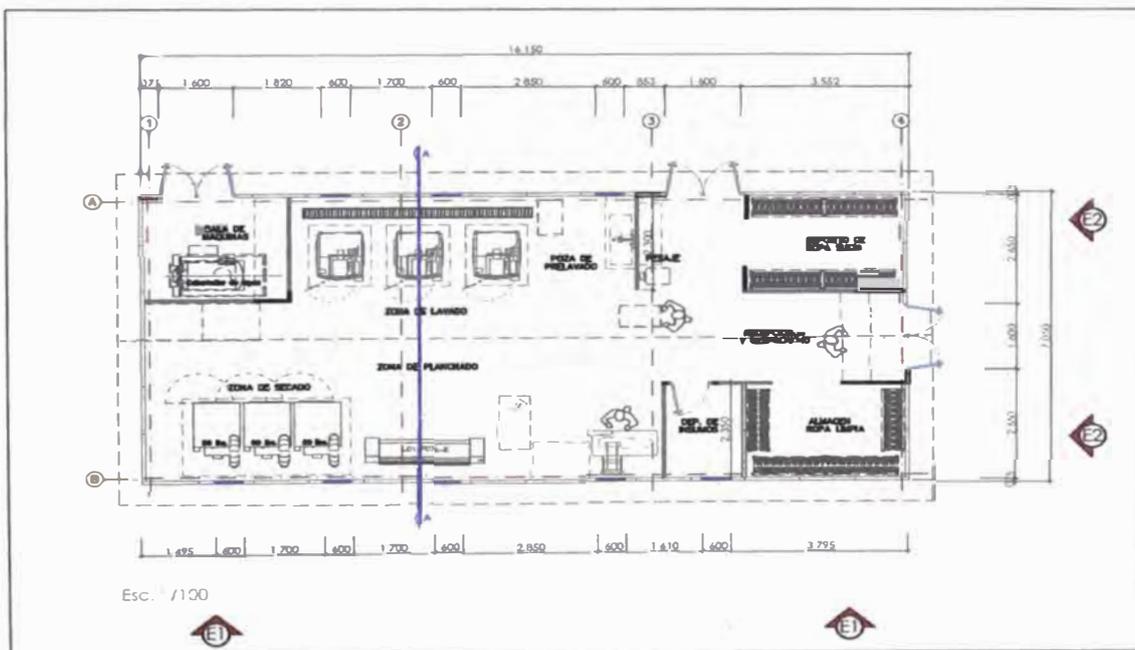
Modulo fijo para uso de lavandería (proyecto campamento ZANJA Buenaventura – en anteproyecto).
